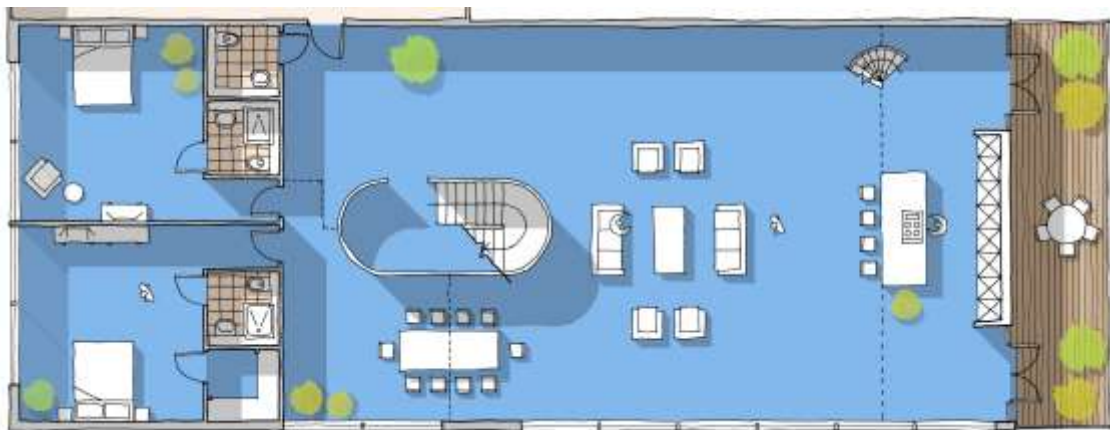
Beispiel einer offenen Grundrissplanung – Erdgeschoss (Broadway Malyan Architects, London)
